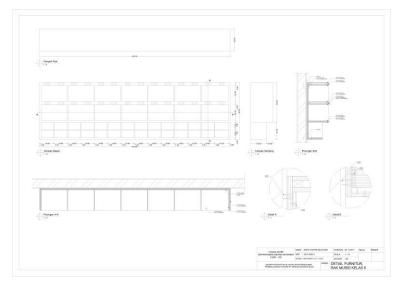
Detail Meja Murid Ruang Kelas 5
